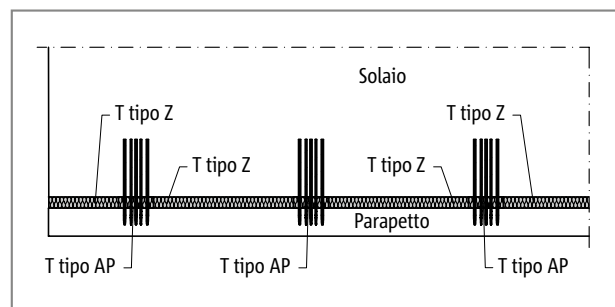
Schöck Isokorb® T tipo AP disposizione orizzontale: pianta parapetto anteposto
